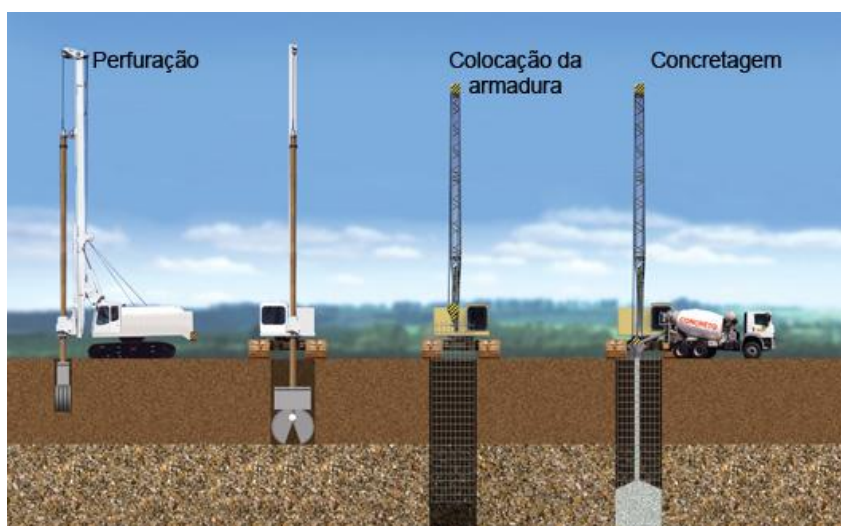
Metodologia executiva de parede moldada “in situ” (site: geofund.com.br).
